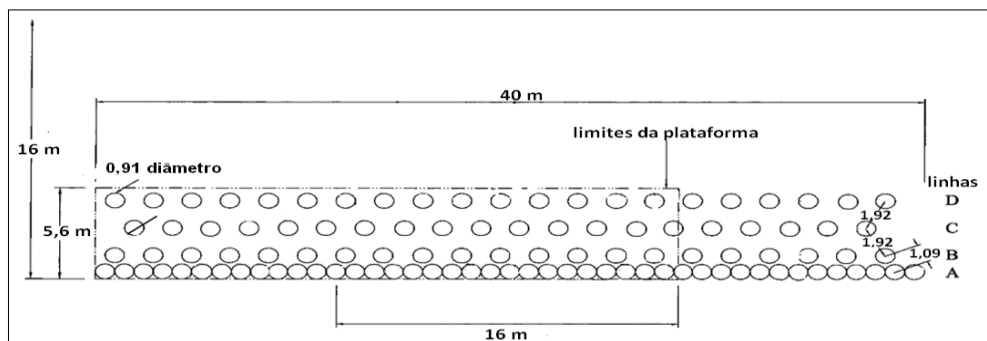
Planta da VERT Wall (adaptado de Briaud *et al*, 2000)
